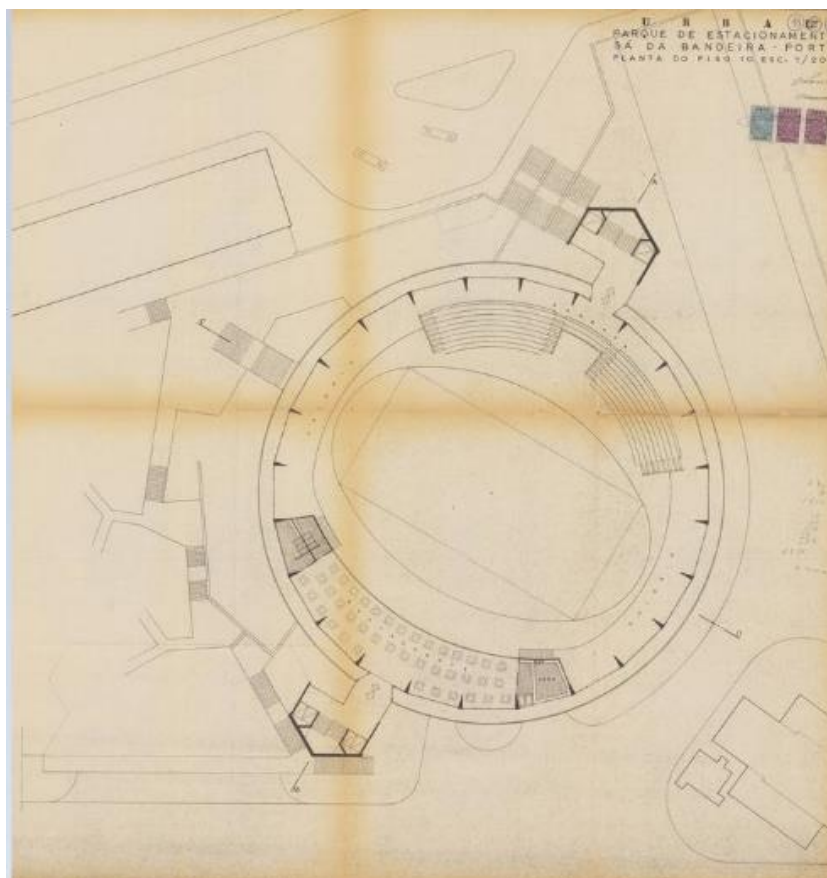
Planta do Piso 8, estádio de Hóquei proposta inicial
